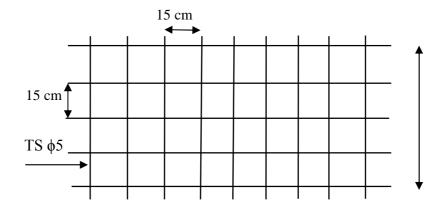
Schéma de ferraillage de la dalle à Corps creux
